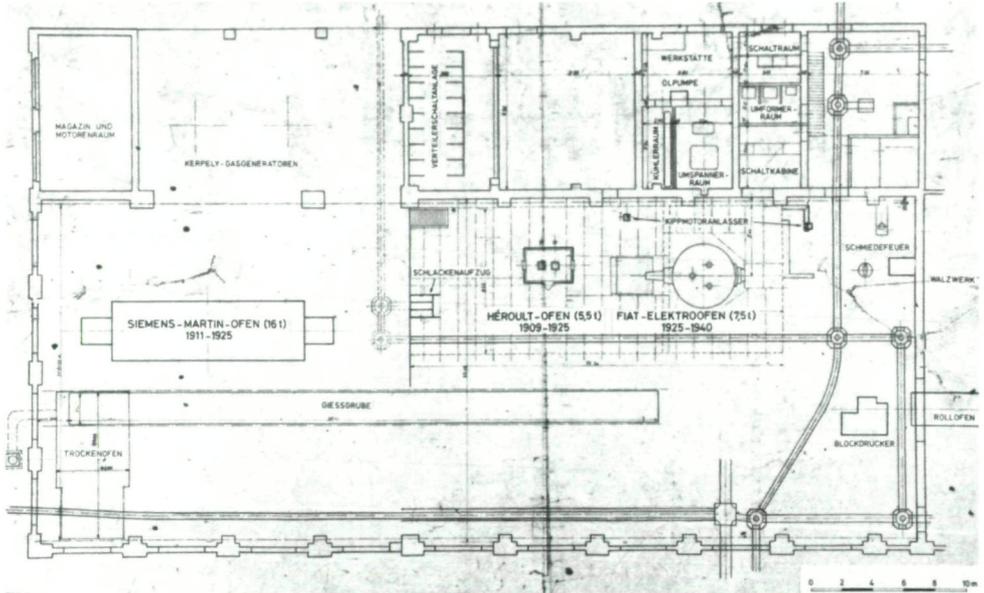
Lageplan des Stahlwerkes der KESTAG in Ferlach. Plan Nr. 4 vom 26. Juni 1925 in der Plansammlung „FIAT-Ofen“ der AUSTRIA DRAHT GmbH in Ferlach (Beschriftung für die Wiedergabe geändert).
